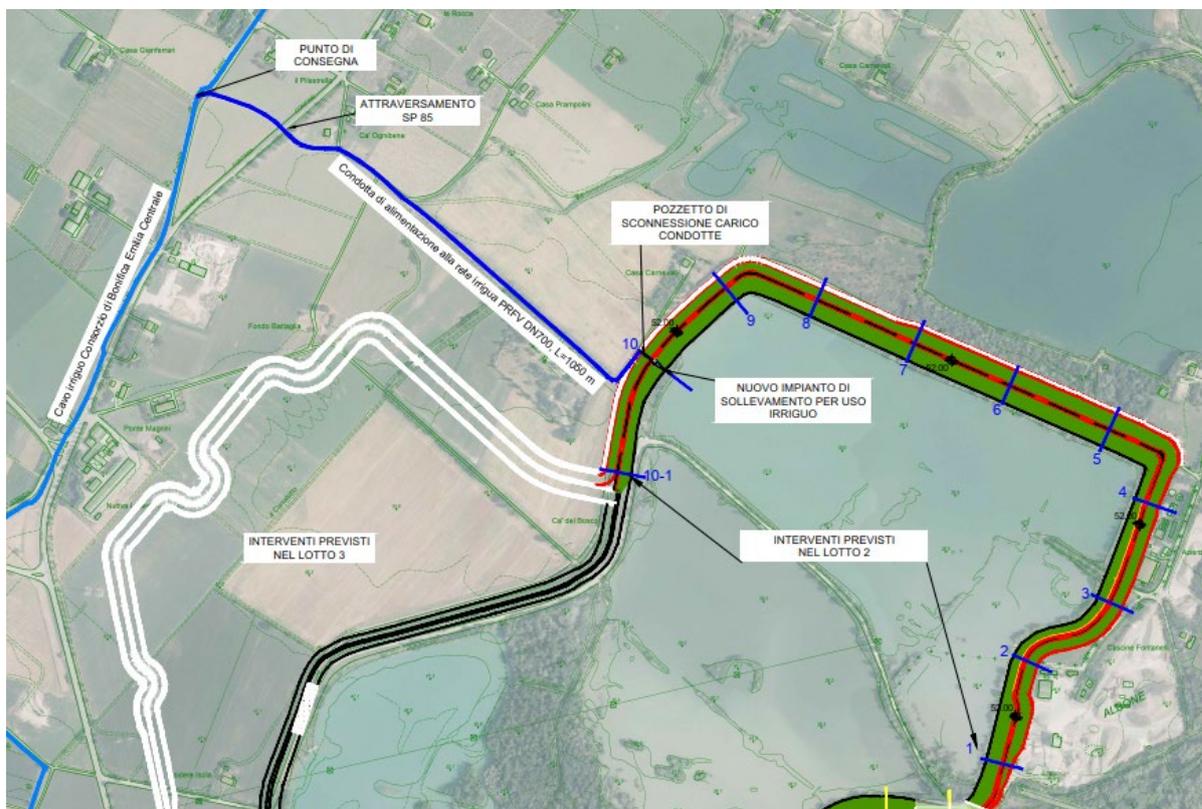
Stralcio della planimetria di progetto con indicati gli interventi previsti nel IV lotto
